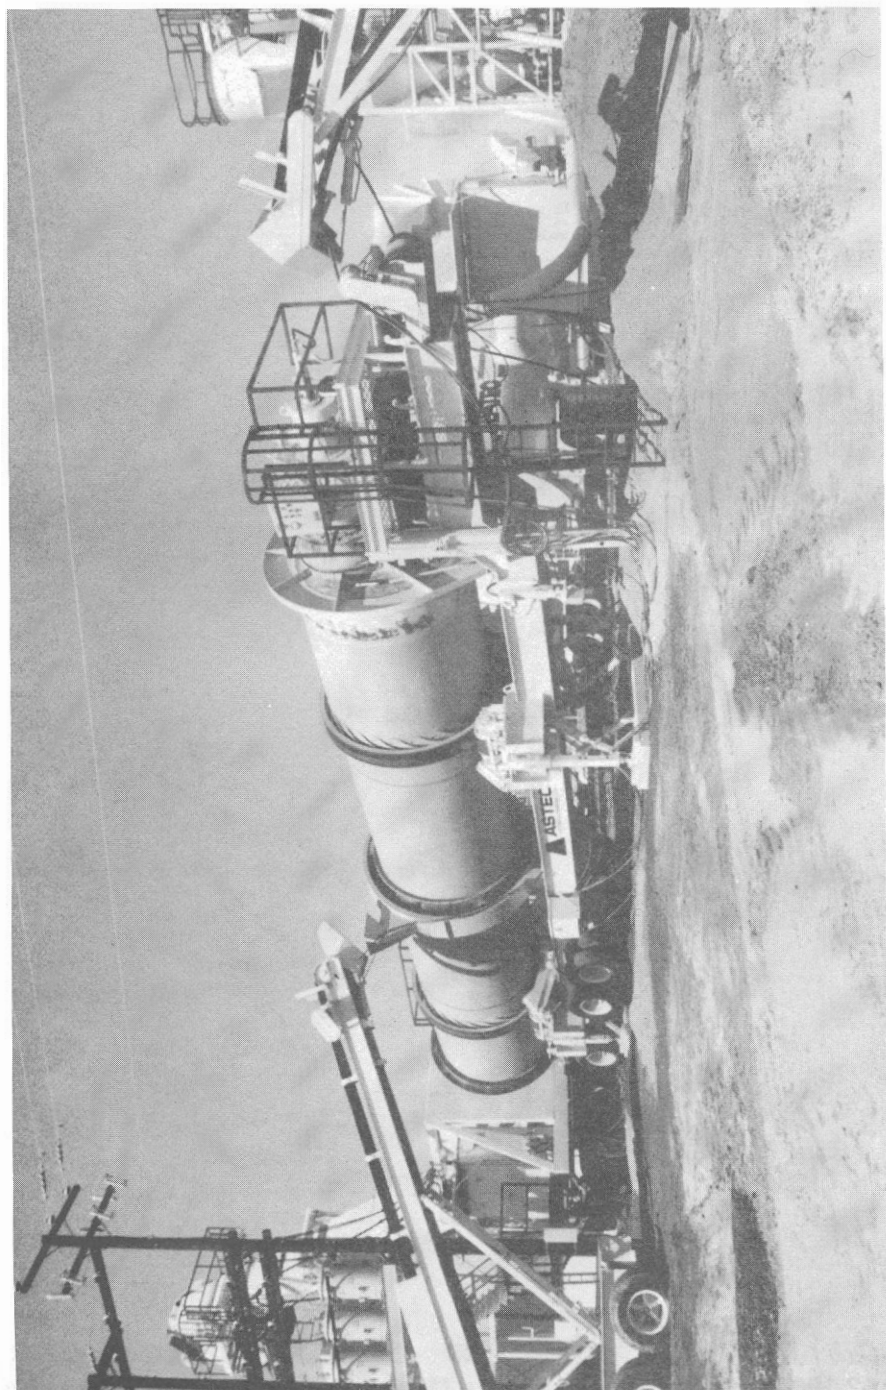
Misturador de Tambor (Cortesía de ASTEC Industries, Inc.)
